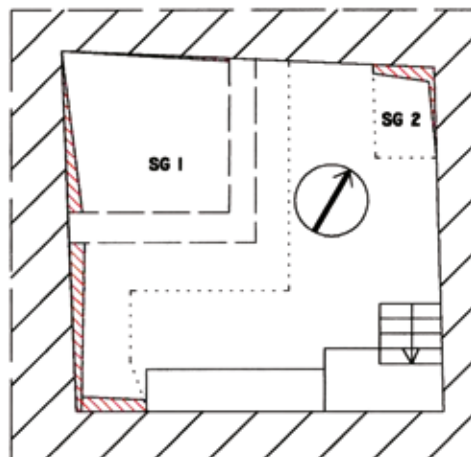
Area dello scavo (riseghe di fondazione in rosso).
